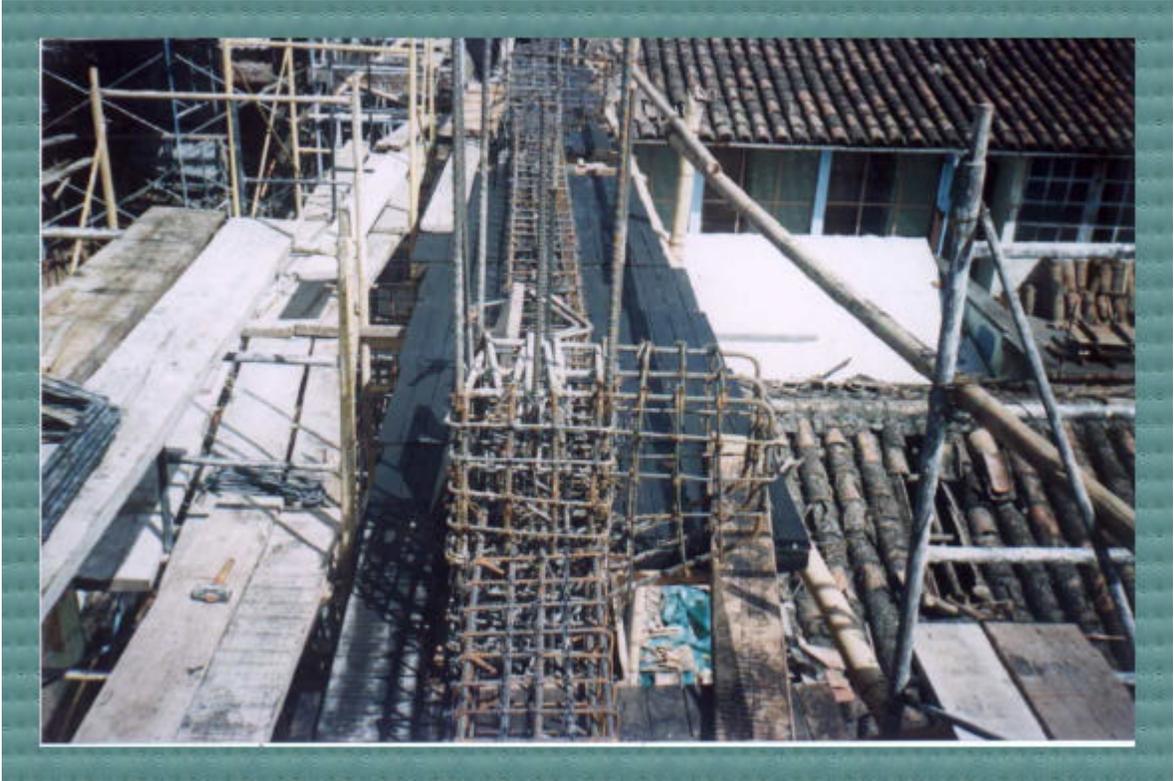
Armado y figurado del hierro de las vigas del quinto y último nivel VD
